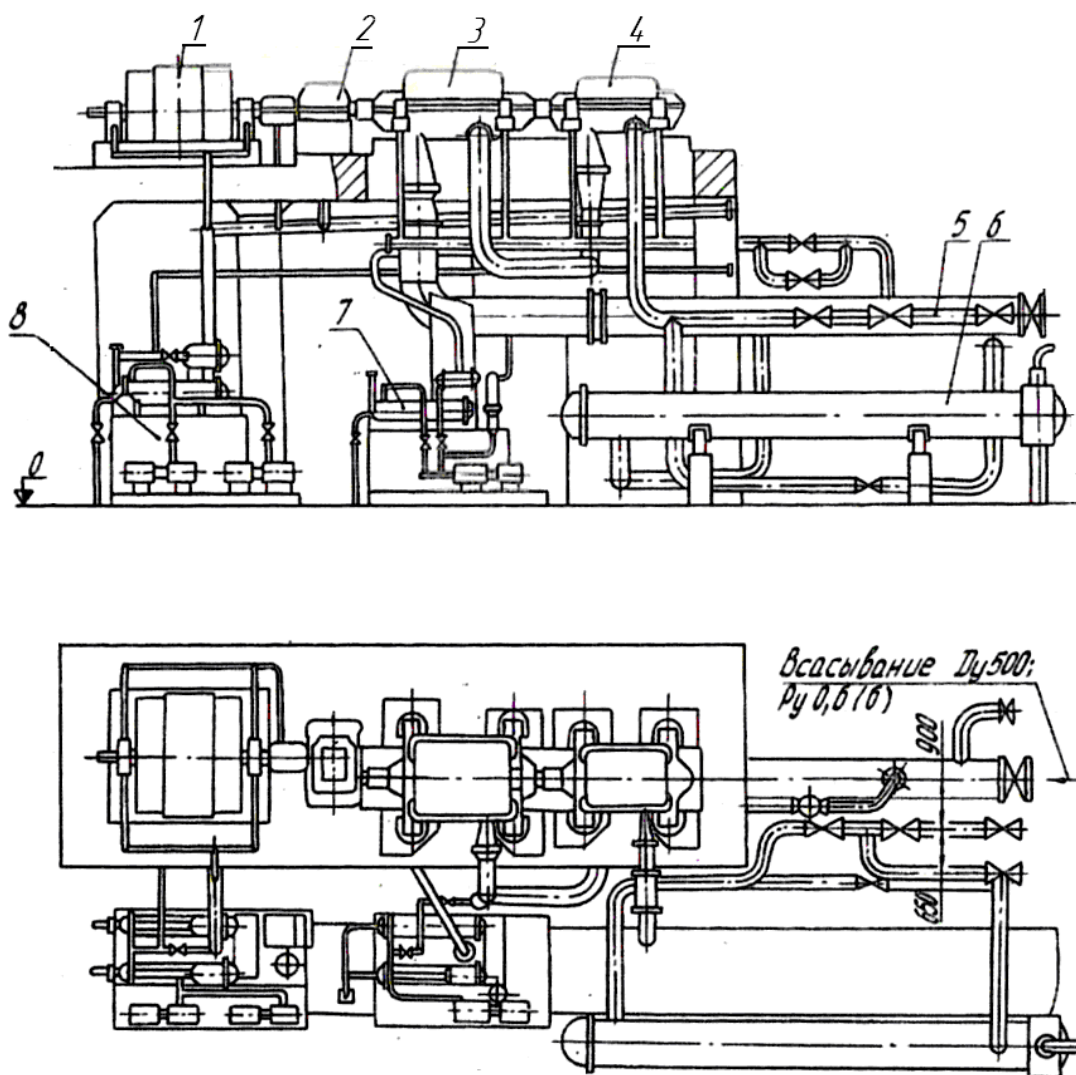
Установка с электроприводным двухкорпусным центробежным компрессором (НИИТК – ККЗ)
